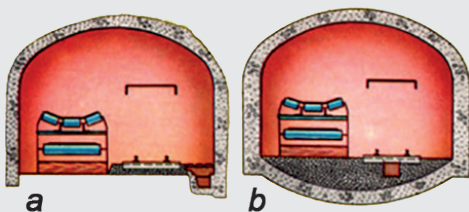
Монолітне бетонне кріплення: а – з вертикальними стінками і склепінчастим перекриттям; б – замкнене зі зворотним склепінням
